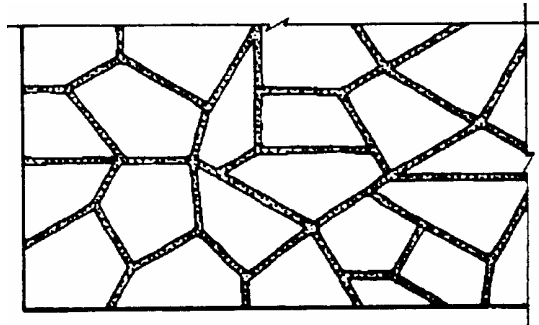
Parede de alvenaria de pedra aparelhada (aparelho poligonal rústico)
